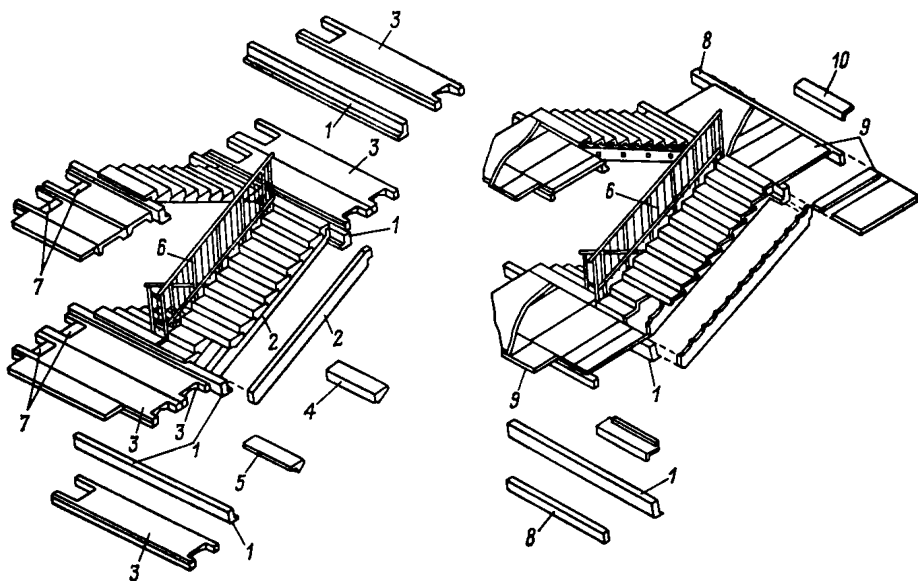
Железобетонные лестницы из крупноразмерных элементов
